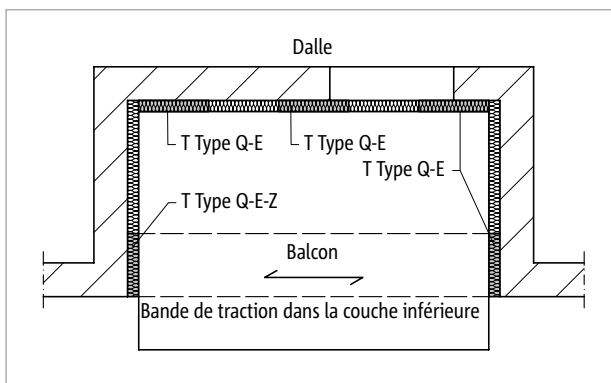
Schöck Isokorb® T Type Q-E, Q-E-Z : Loggia soutenue sur trois côtés avec bande de traction
